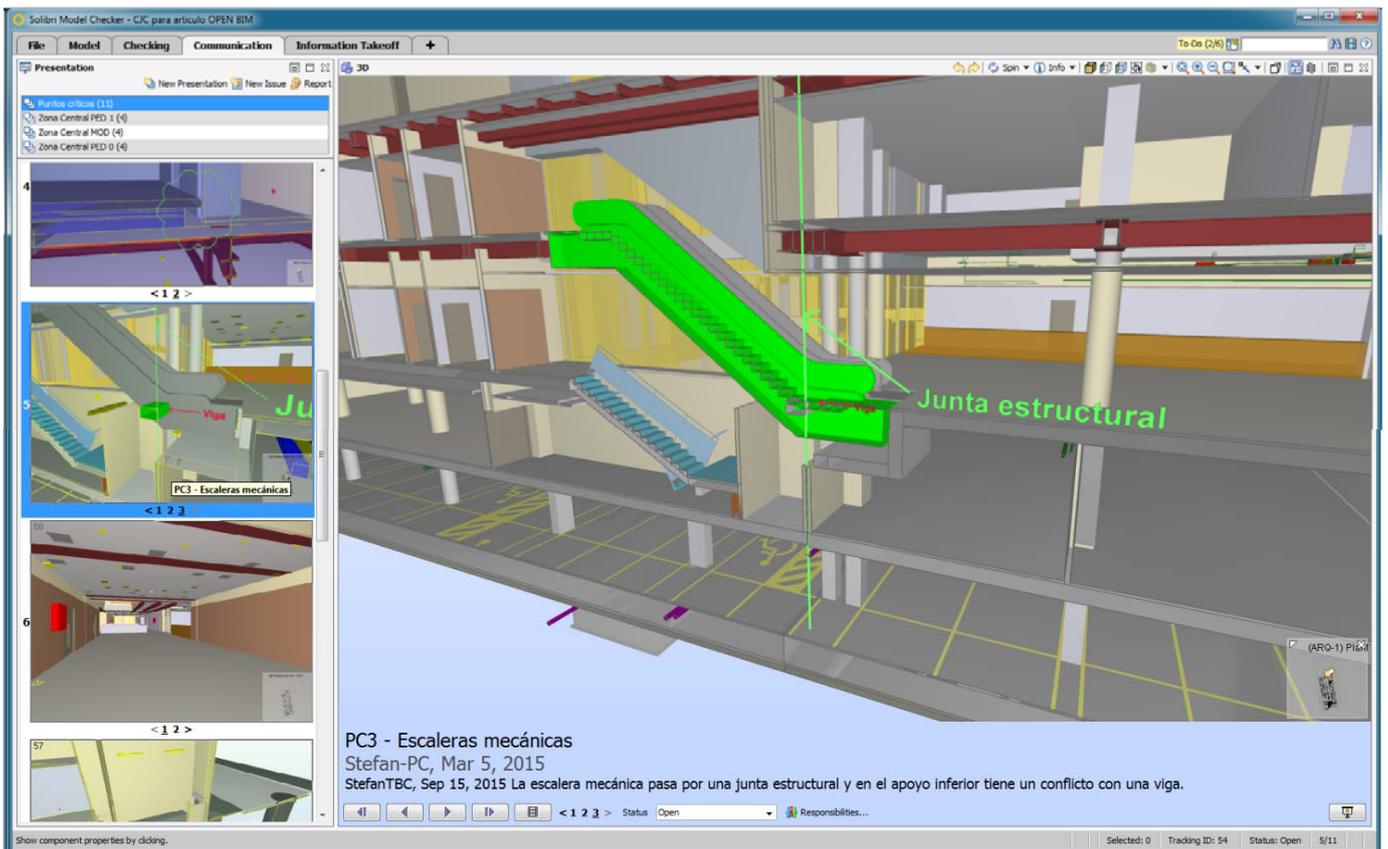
Detección de conflicto entre las escaleras mecánicas, de plata baja a primera, y la estructura
